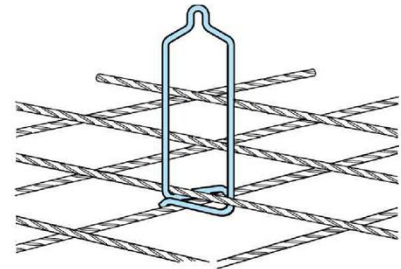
Unter gleichzeitigem Zusammendrücken der Schenkel mit Rechtsdrehung auf unteren Bewehrungsstab einschnappen lassen.
